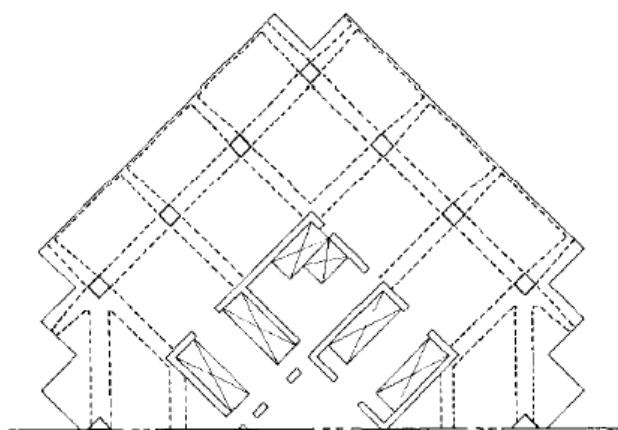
Pianta tipica dell'edificio di 70 piani in c.a. [9]
